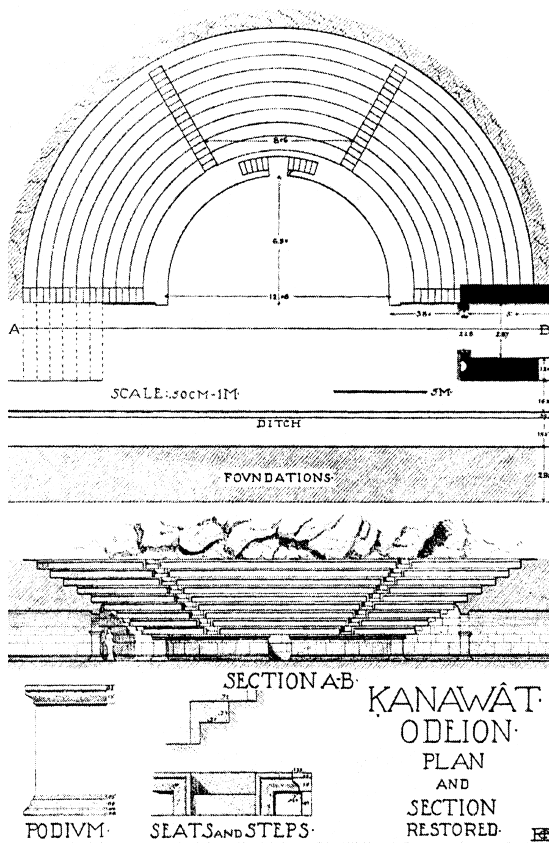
Das Odeion von Kanatha. Rekonstruktion, Grundriss und Schnitt (Meinel 1980, Abb. 113)
